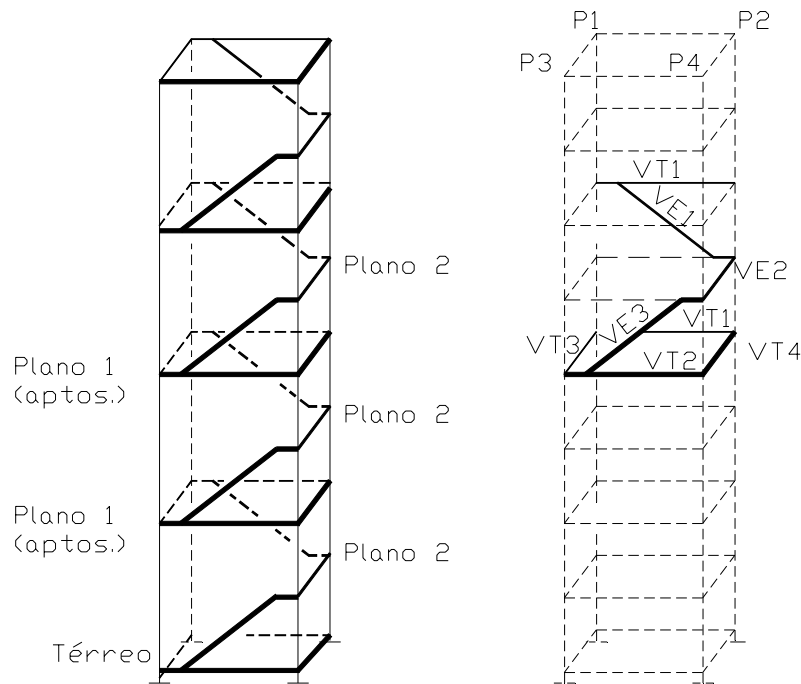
Esquema das ligações entre vigas e pilares (sem escala)
